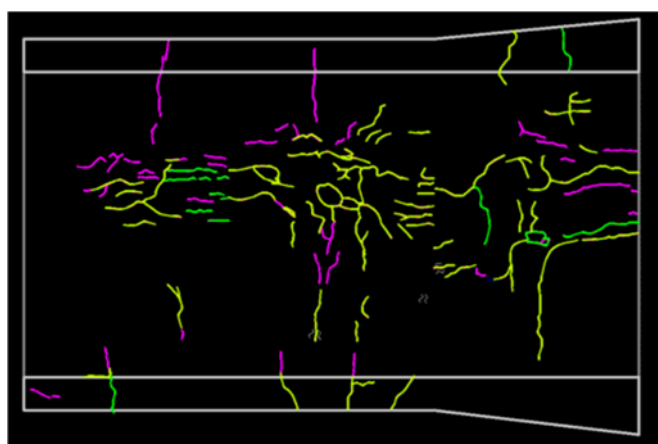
(b) ひび割れの点検時期による変動例（重合せ）
